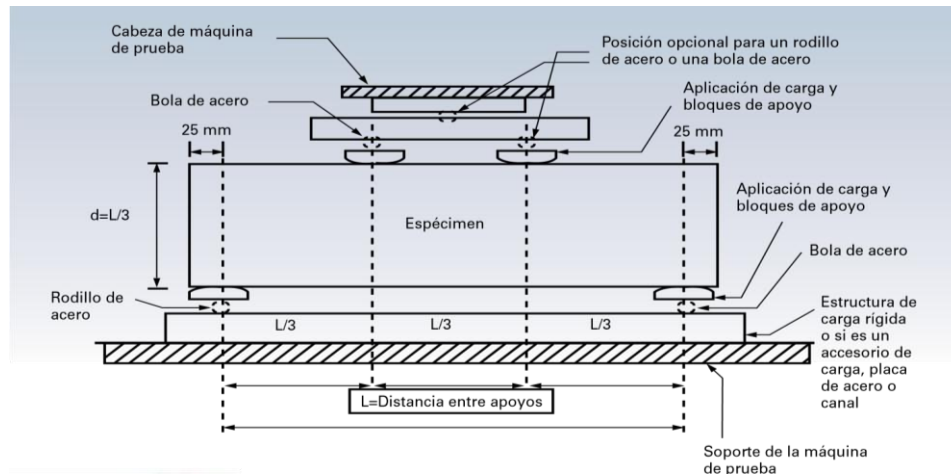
Dimensiones permisibles de apoyos según norma ASTM C293 para ensayos en vigas de concreto para pruebas de deflexión. (instituto mexicano del cemento y concreto ac)
